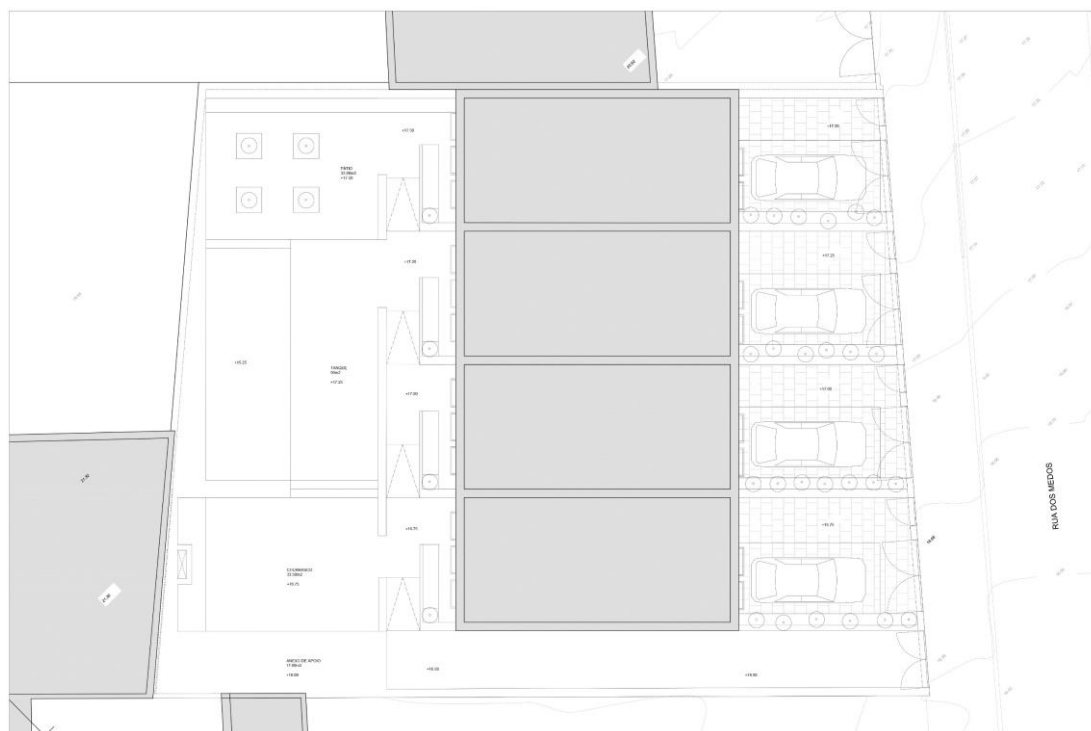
Planta da implantação. Projecto 4. Fonte: Arkstudio.
